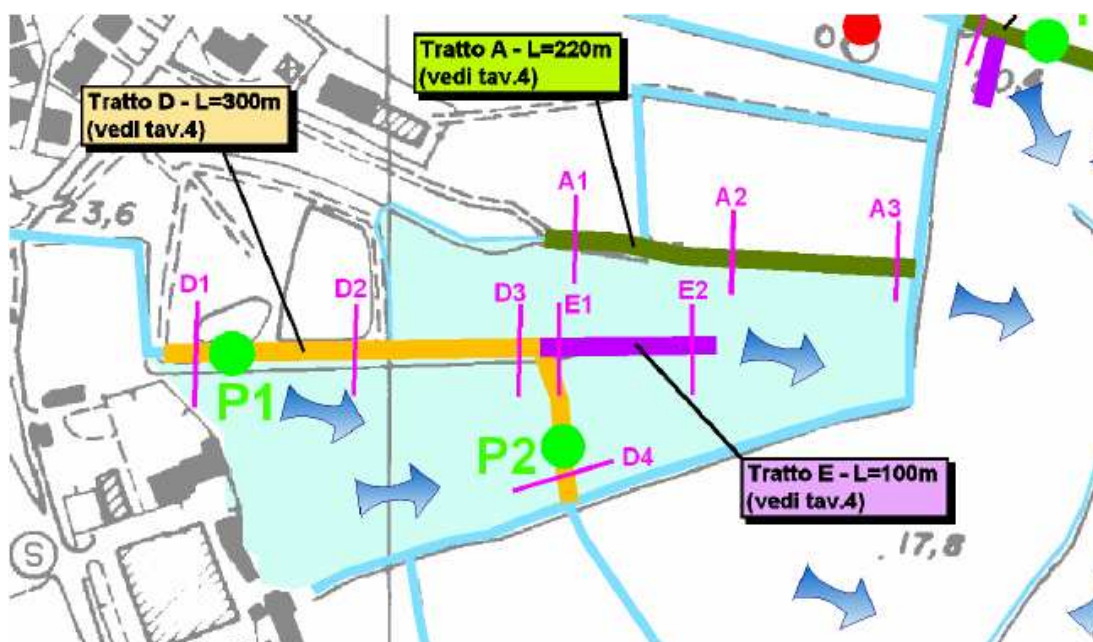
Localizzazione dell'intervento pilota (area di 5 ettari).
